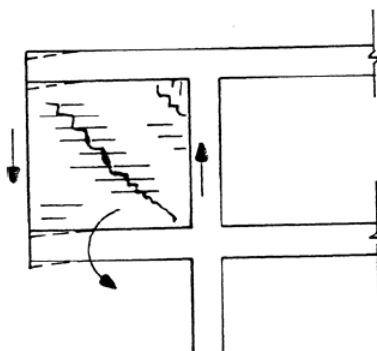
Fissuração em vãos de alvenaria em elementos em consola [1]
